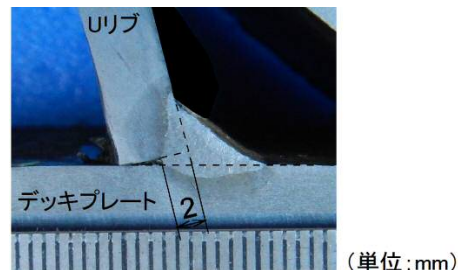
Uリブ溶接部のマクロ(供試体B-2, R側)
